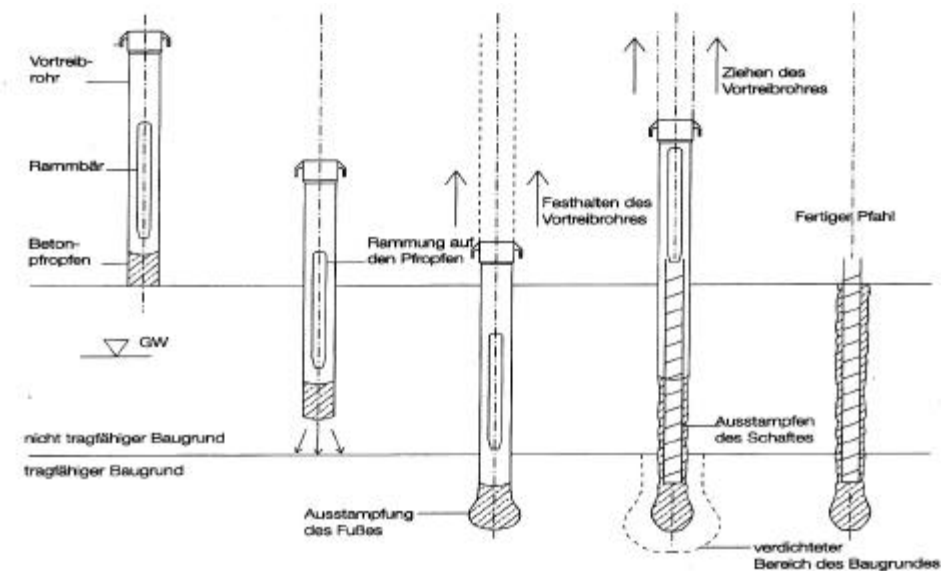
Ort beton-Rammpfahl, Franki Pfahl [Phocas 2001, S. 92]
